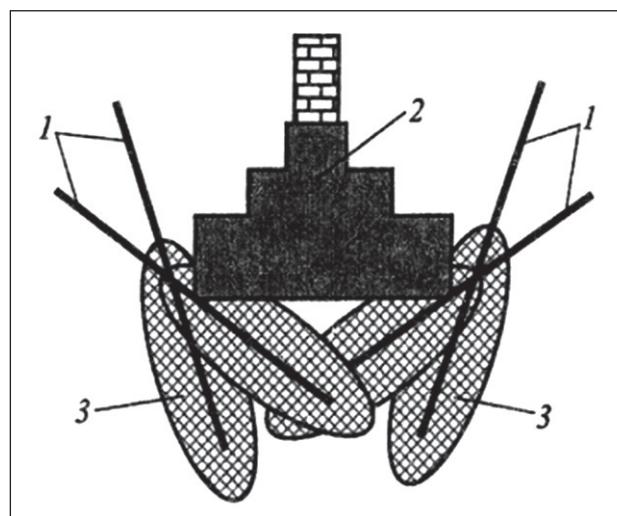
Усиление фундамента. 1 – инъектор; 2 – фундамент; 3 – укрепленная зона
